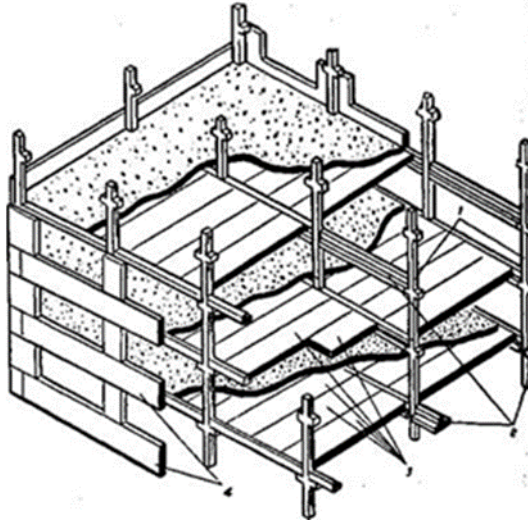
Схема каркаса будівлі: 1 – колони, 2 – ригелі, 3- плити перекриття, 4 – панелі зовнішніх стін.
